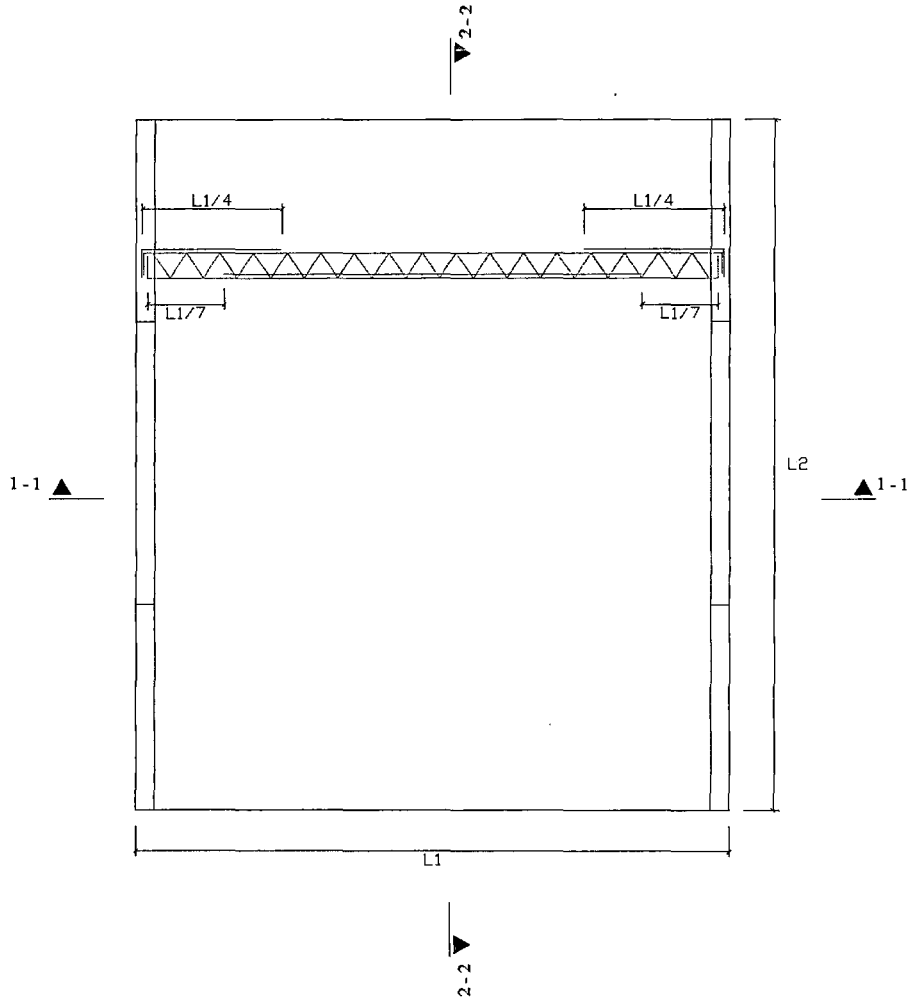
Vista en Planta de una Edificación que emplea Tridilosa (Estructuración C)
